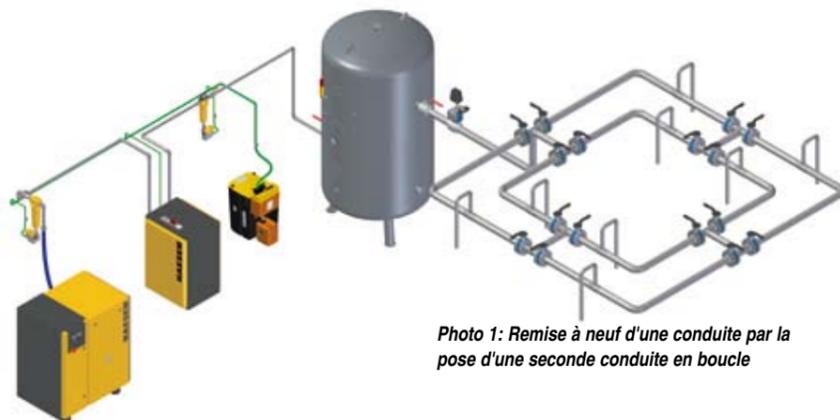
Remise à neuf d'une conduite par la pose d'une seconde conduite en boucle
